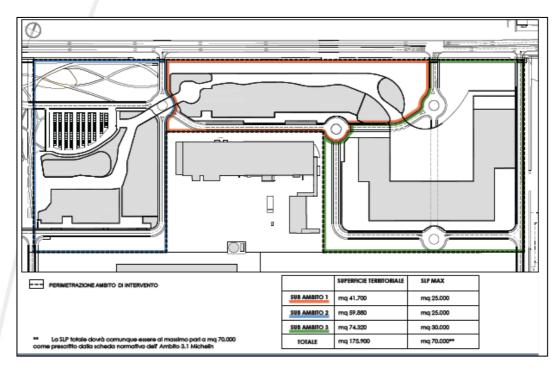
Planimetria generale con indicazione della perimetrazione dei Sub Ambiti del SUA – Tavola prescrittiva
